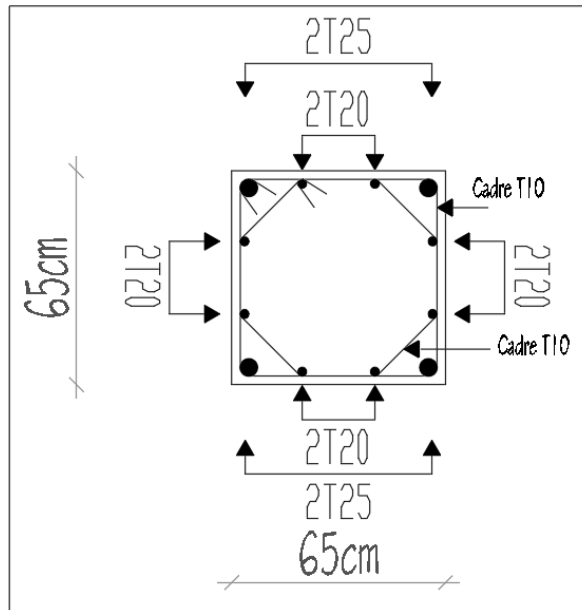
le schéma de ferrailage des poteaux 65*65
